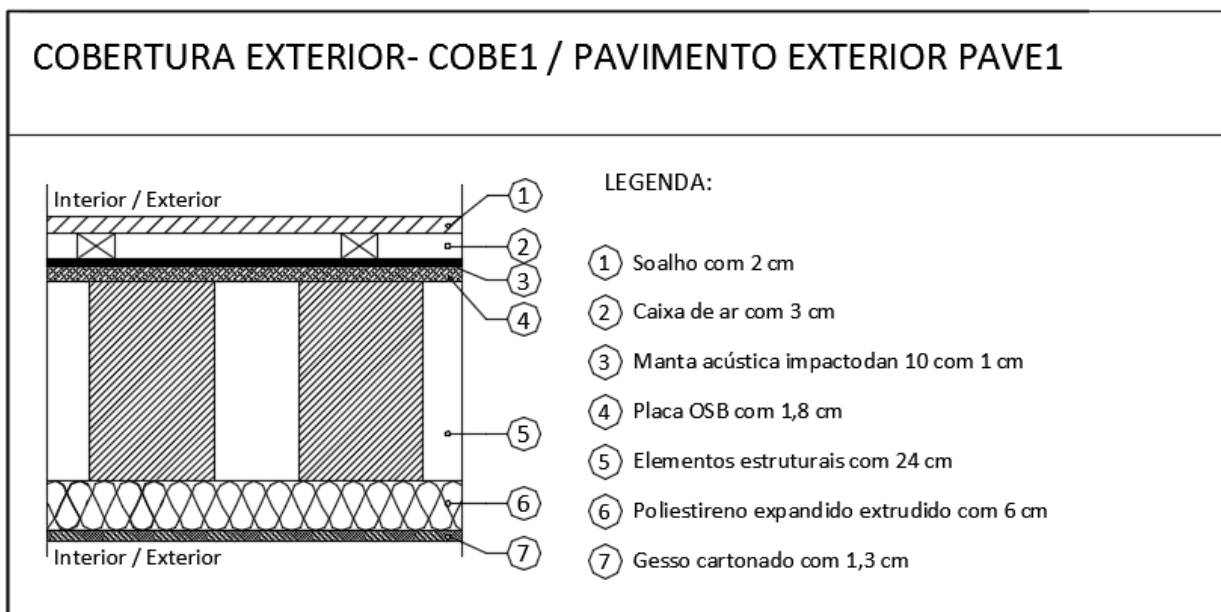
Esquema representativo da solução construtiva da cobertura/pavimento exterior (COBE1/PAVE1)
